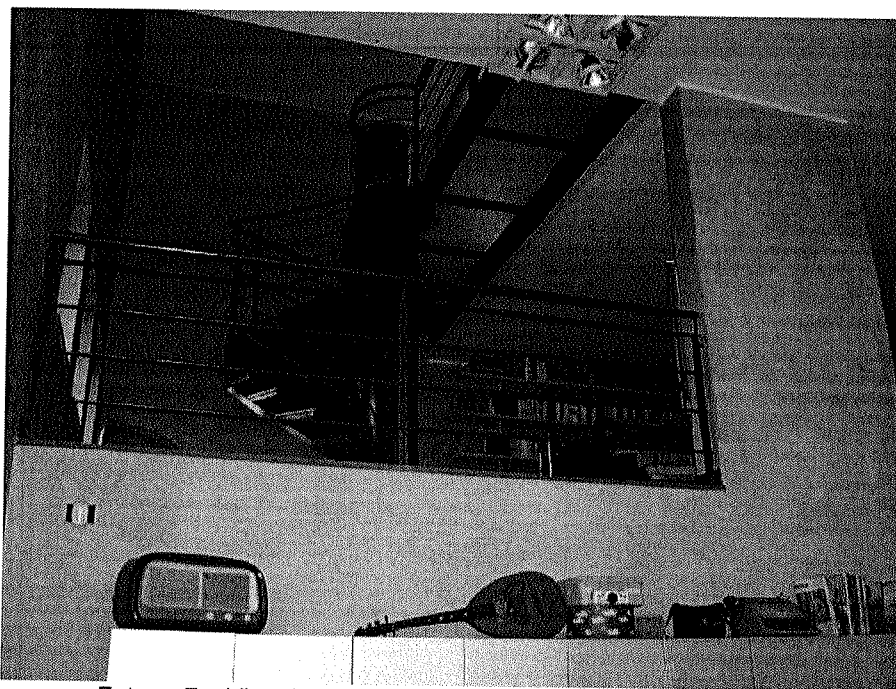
Vista interna: scala che conduce al piano secondo
